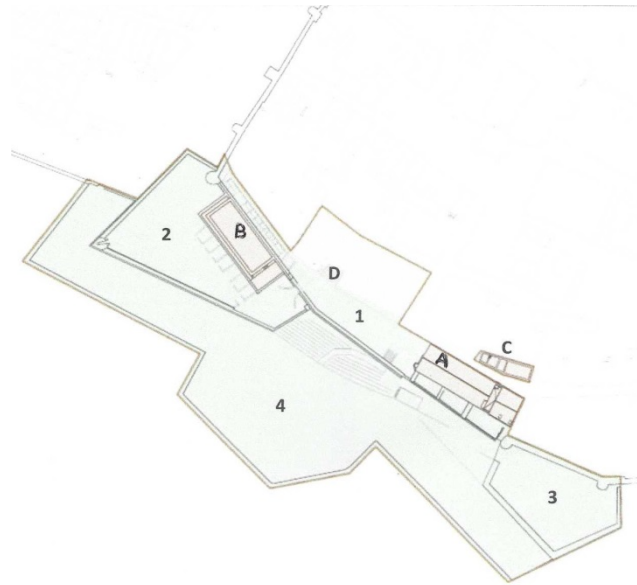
Área destinada à instalação do estabelecimento hoteleiro ou outro projeto de vocação turística
